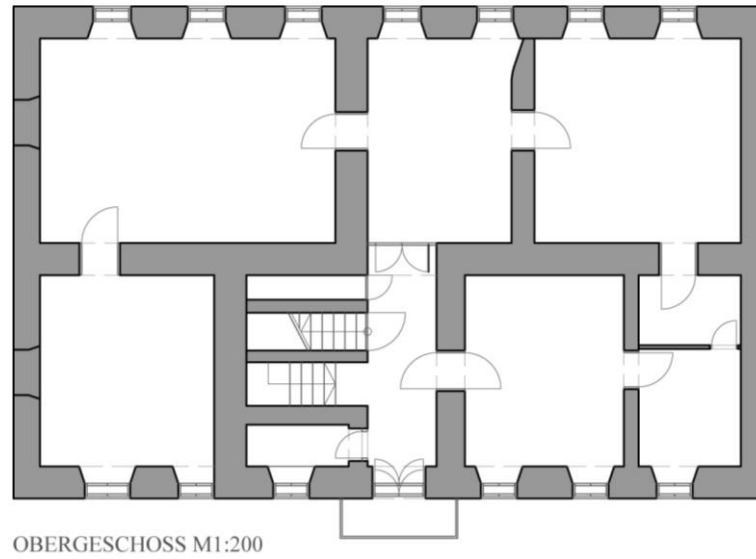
Grundriss Obergeschoß, Bestand, Pfarrhaus Winden am See.
